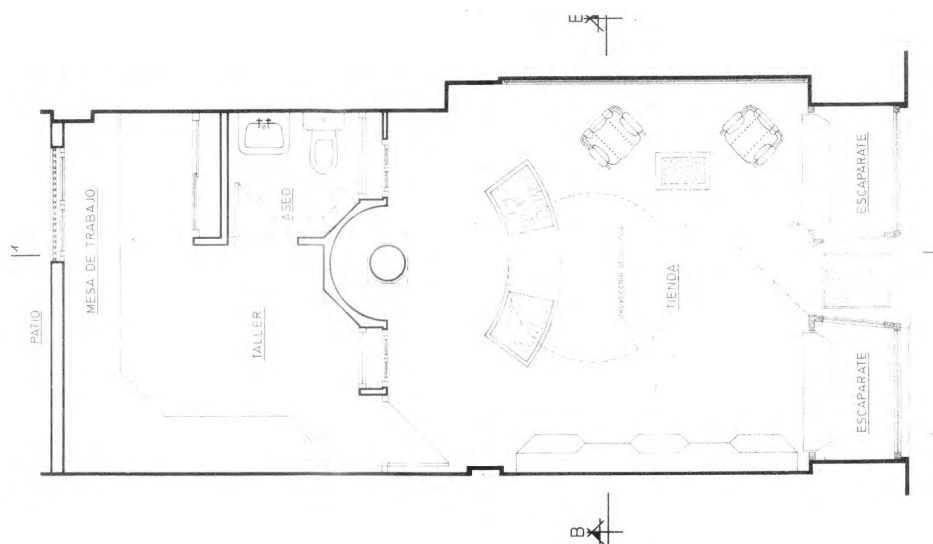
22. PLANTA DE PROPUESTA DE REFORMA EN LOCAL PARA INSTALAR UNA JOYERÍA TALLER¹⁷
